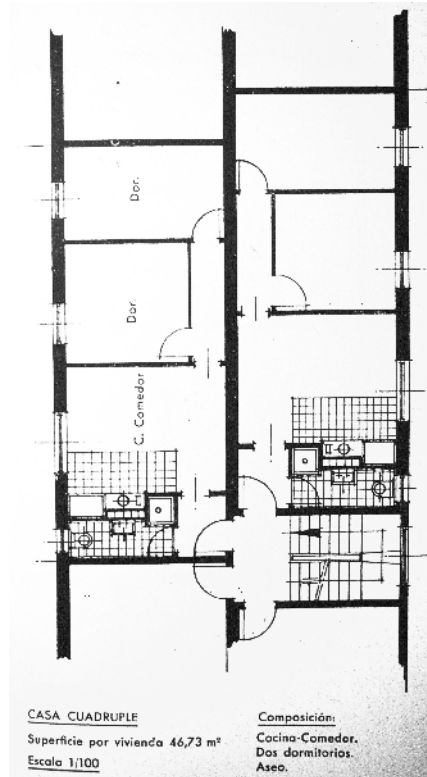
Esquema de una planta de 46,73 m². Pág. 14
